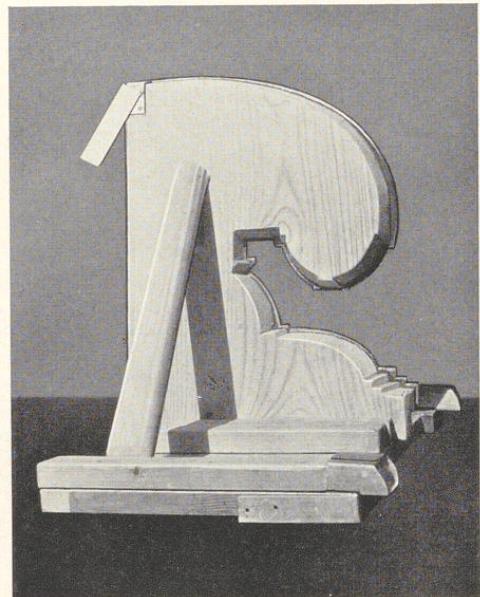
Die Eckschablone von der Rückseite gesehen. Der Profilausschnitt konisch gearbeitet
